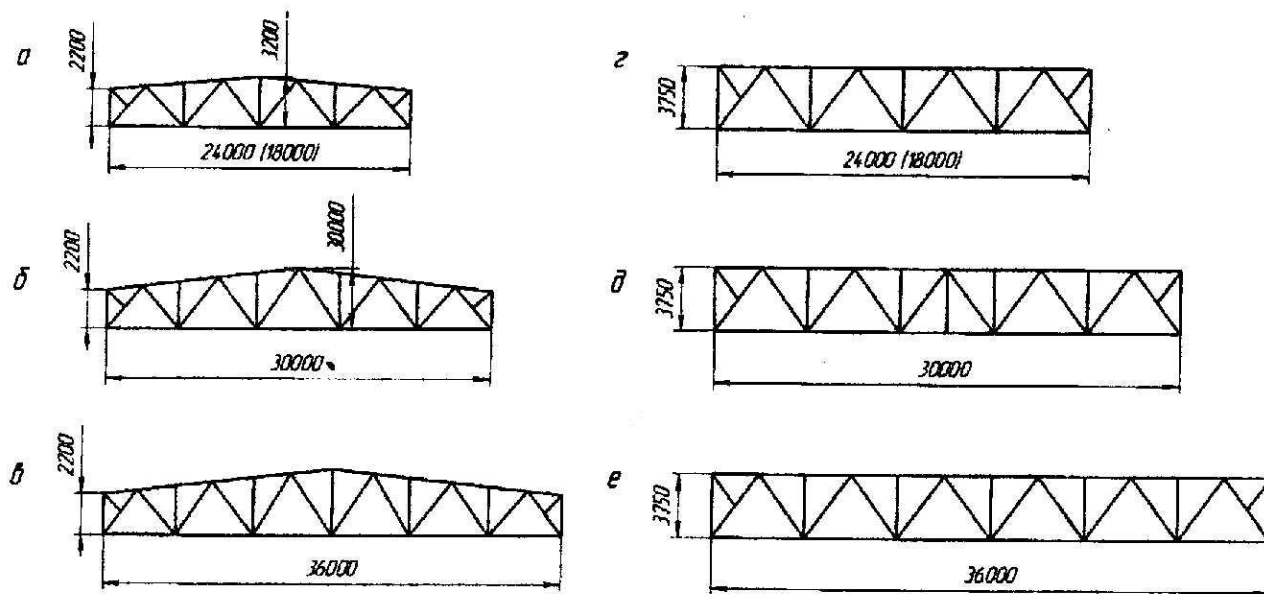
Габаритные размеры стальных ферм покрытий
